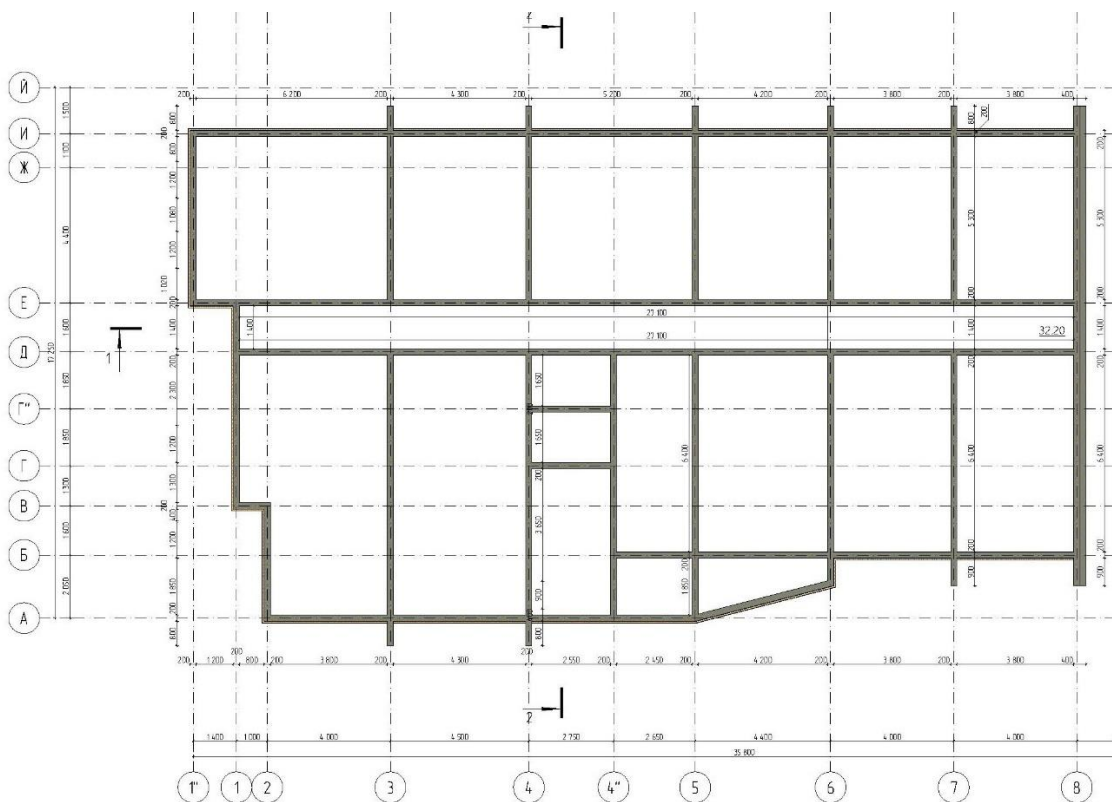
План фундаментных стен на отметке – 8.620
